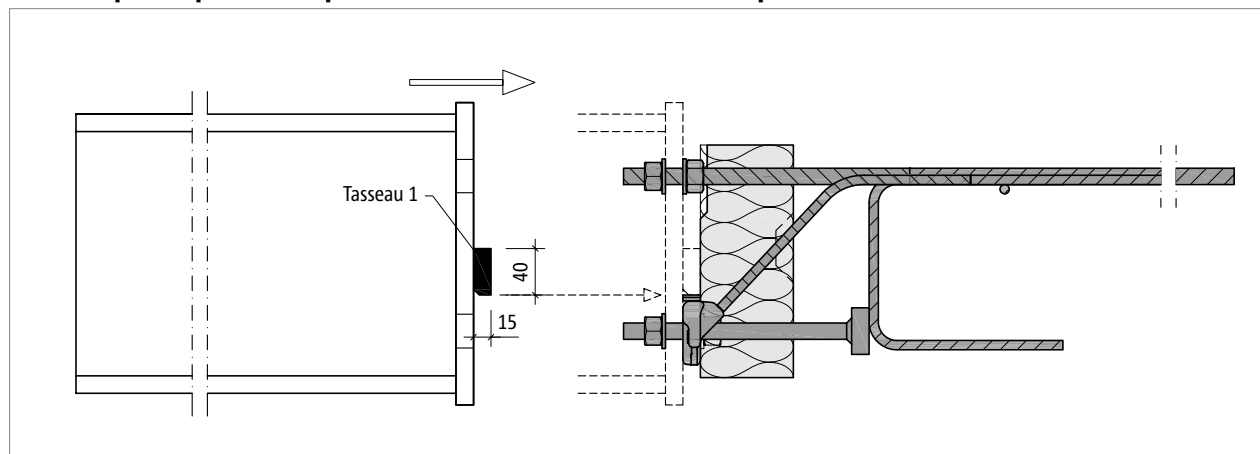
Schöck Isokorb® T type SK : montage de la poutre en acier
